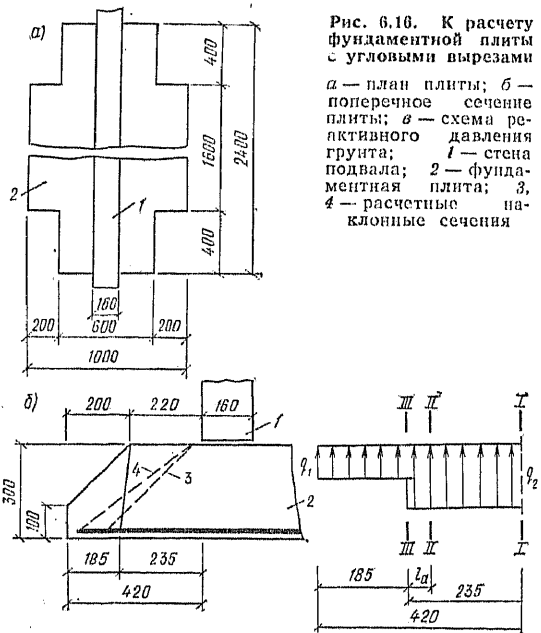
К расчету фундаментной плиты с угловыми вырезами
